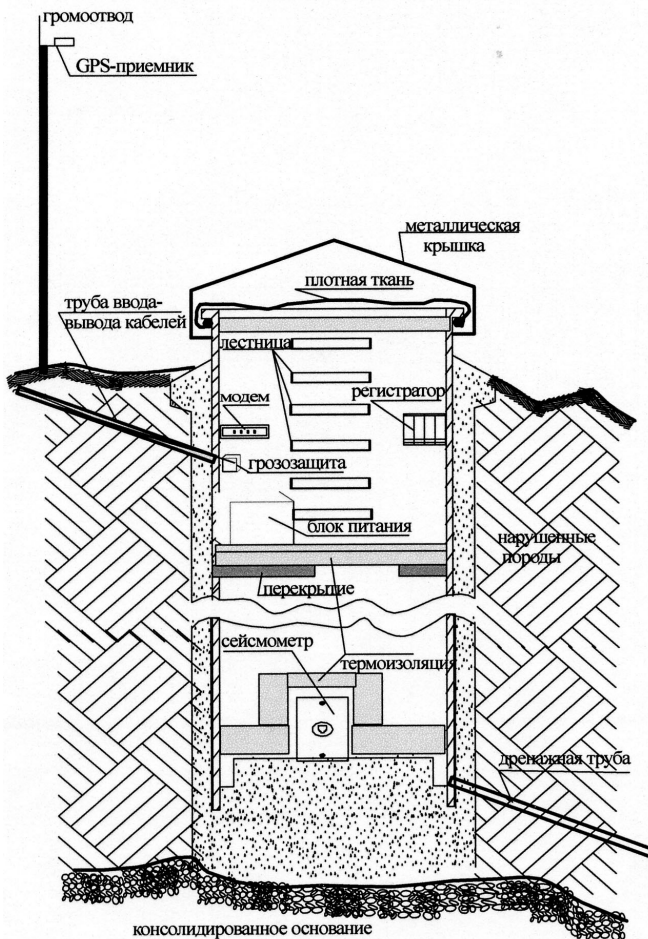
Вариант подземного помещения с теплоизоляцией
